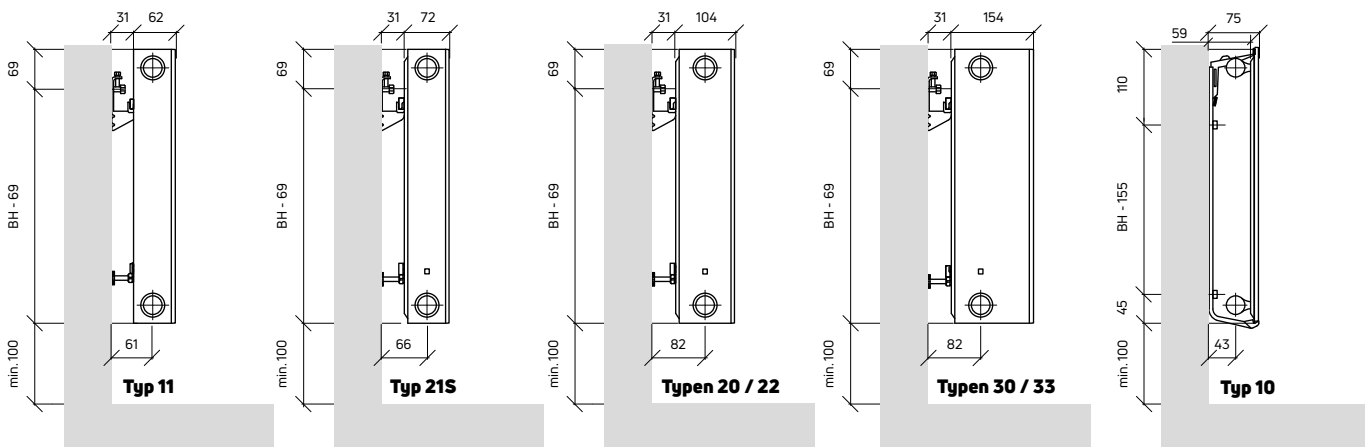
Montagemaße für Plan Compact und Ramo Compact mit Befestigungslaschen
